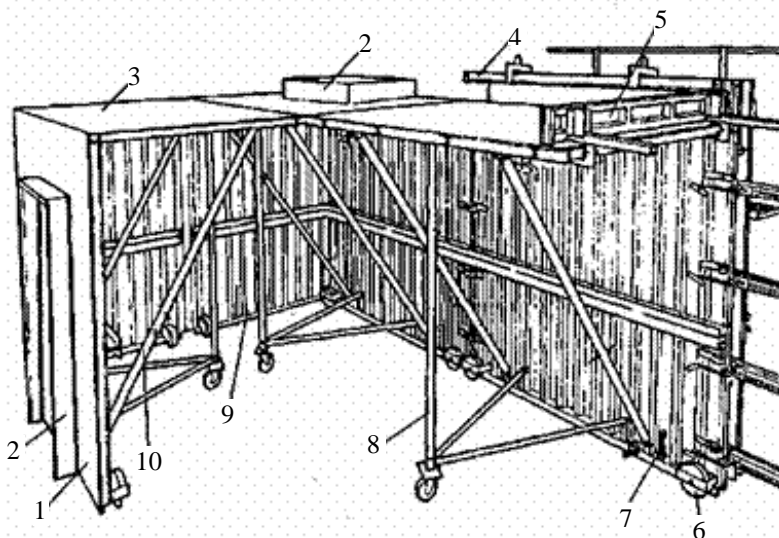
Схема тунельної опалубки: 1 – панель вертикальна; 2 – прорізоутворювач із магнітними зачіпками; 3 – панель горизонтальна; 4 – опалубка бетонування цоколю; 5 – торець огорожувальної стінки опалубки; 6 – колесо роликове; 7 – домкрат регулювальний; 8 – центральний опорний стійок; 9 – панель задня; 10 – підкіс
